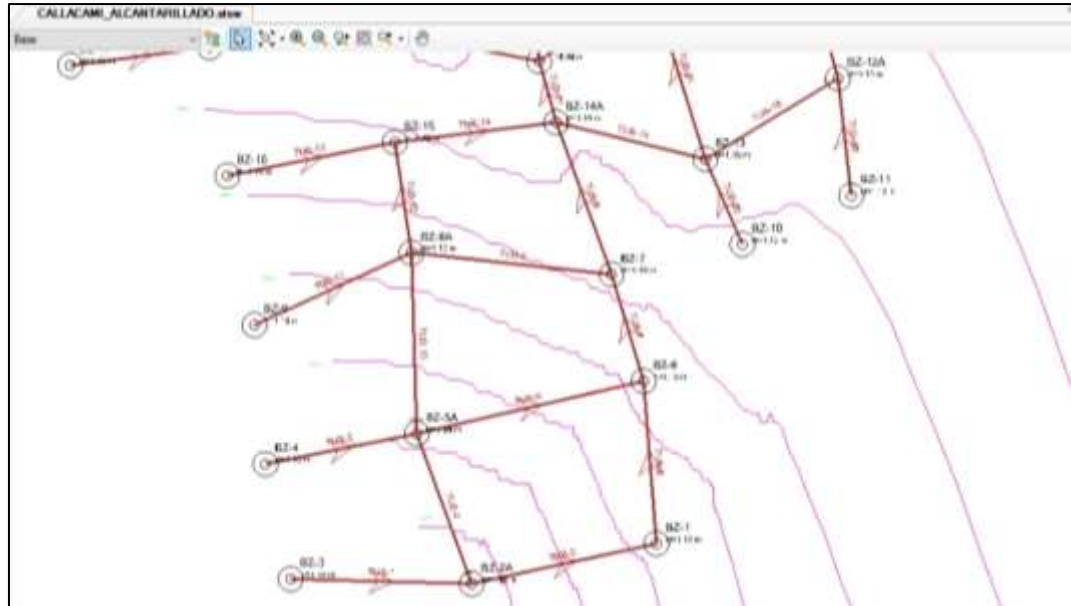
Diseño de Alcantarillado con el modelo SewerCAD; Fuente: elaboración propia.
